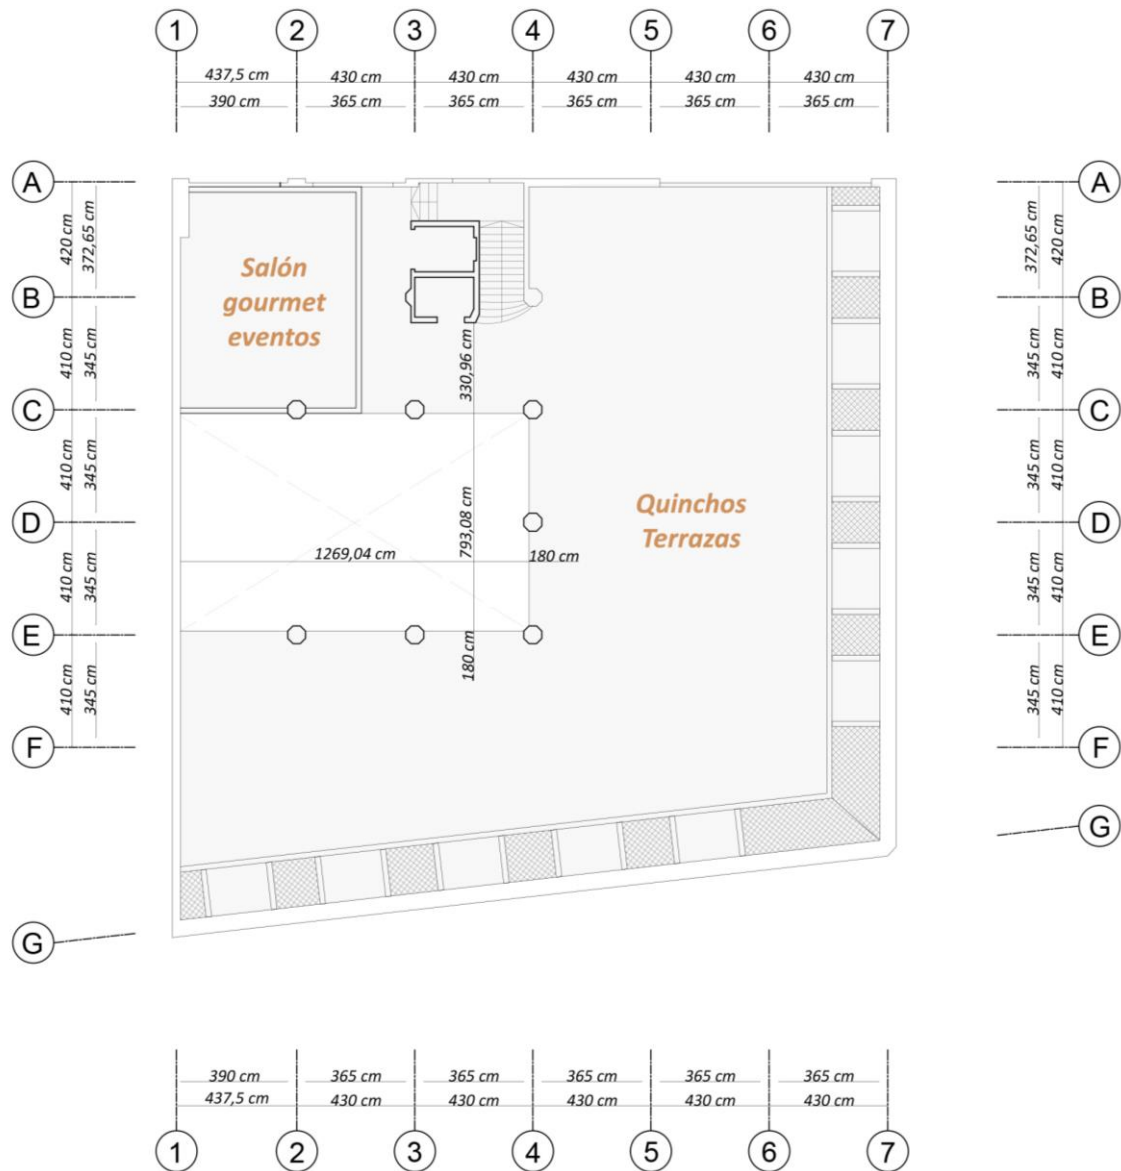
Planta azotea, quinchos, terrazas y salón gourmet, elaboración propia.
